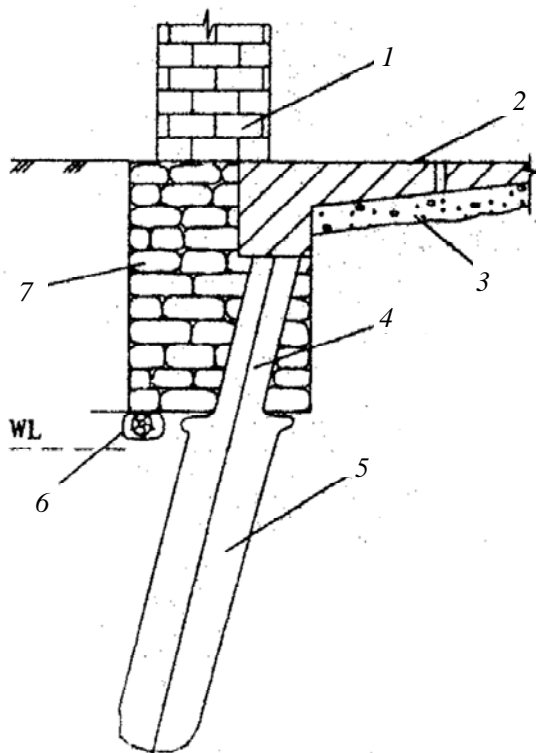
Устройство короткой сваи-шпоры и железобетонной плиты:
